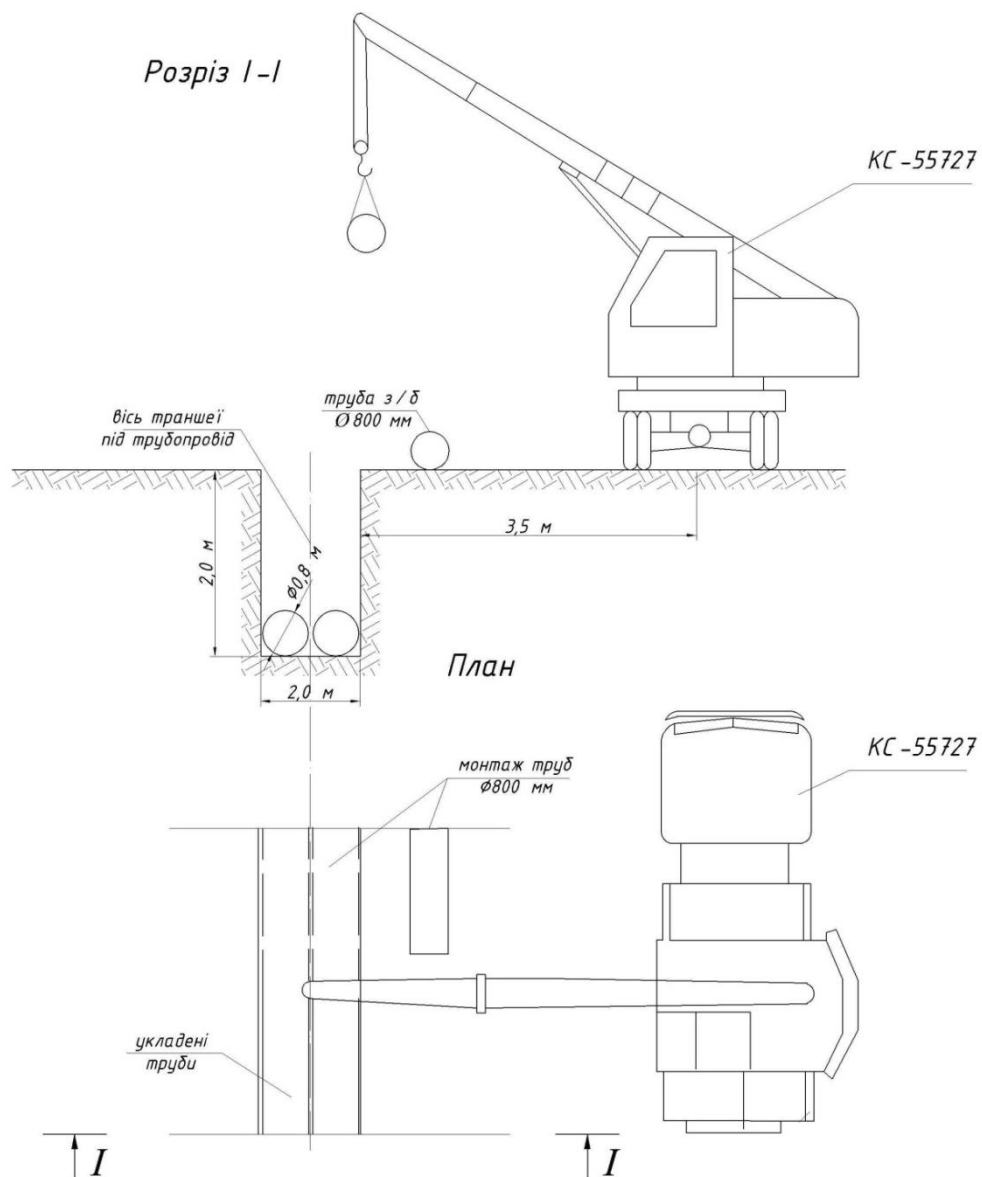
Технологічна схема монтажу трубопроводу
